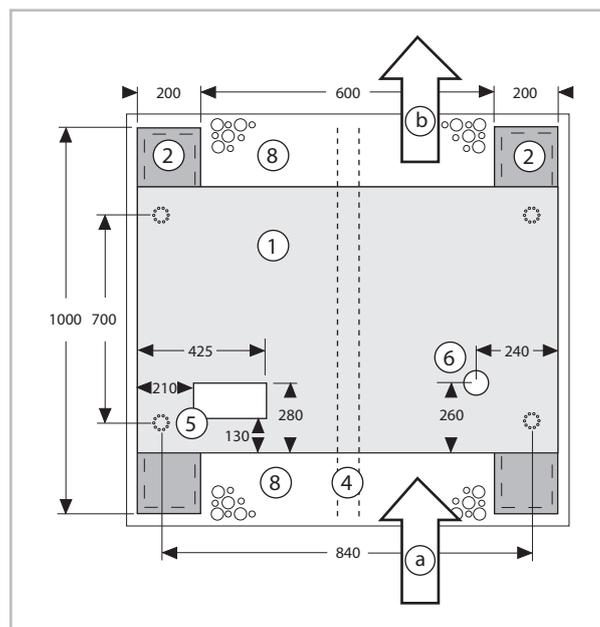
Dimensions de la semelle filante (vue du dessus)
